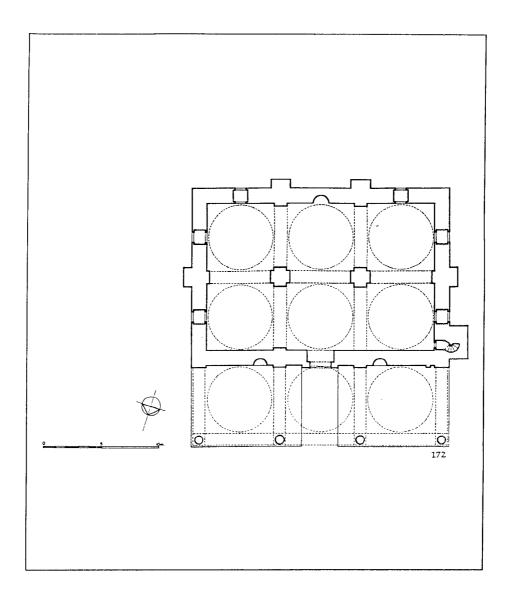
مسقط أفقي لمسجد خداوندكار في فيلبه (عن : ايفردي) .
